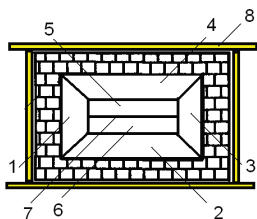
Схема предохранительной разрушающейся конструкции ограждения зданий.
